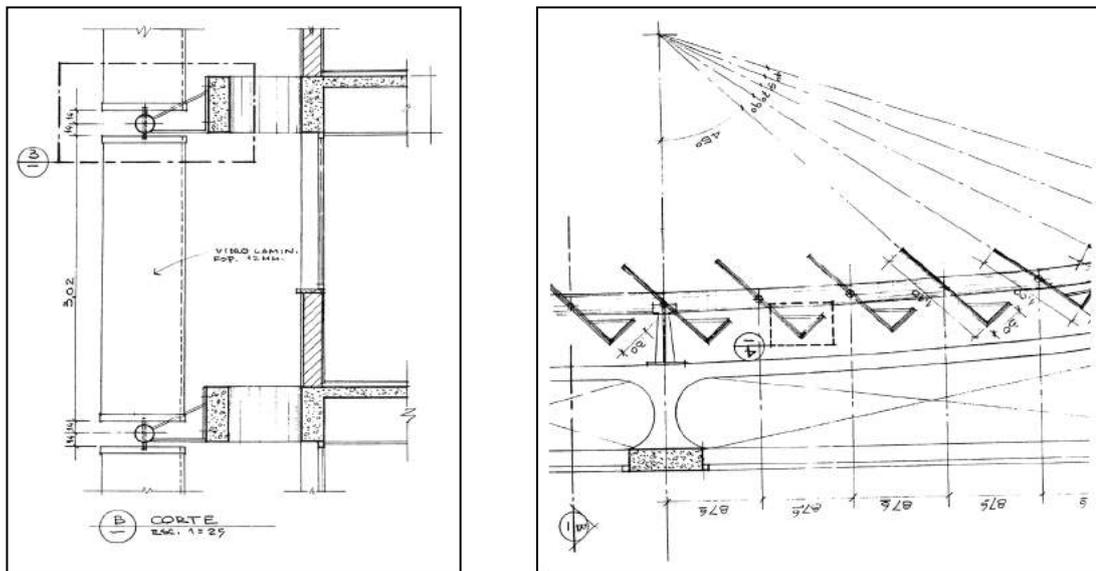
Detalhe encaixe dos brises de vidro - Planta
